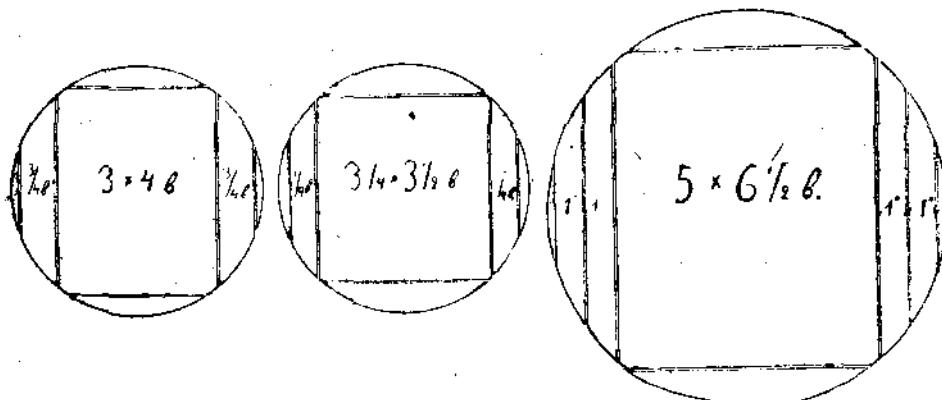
Выпиловка из 5-ти вершкового бревна бруса, размерами 3×4 вершка и двух обрезов.
